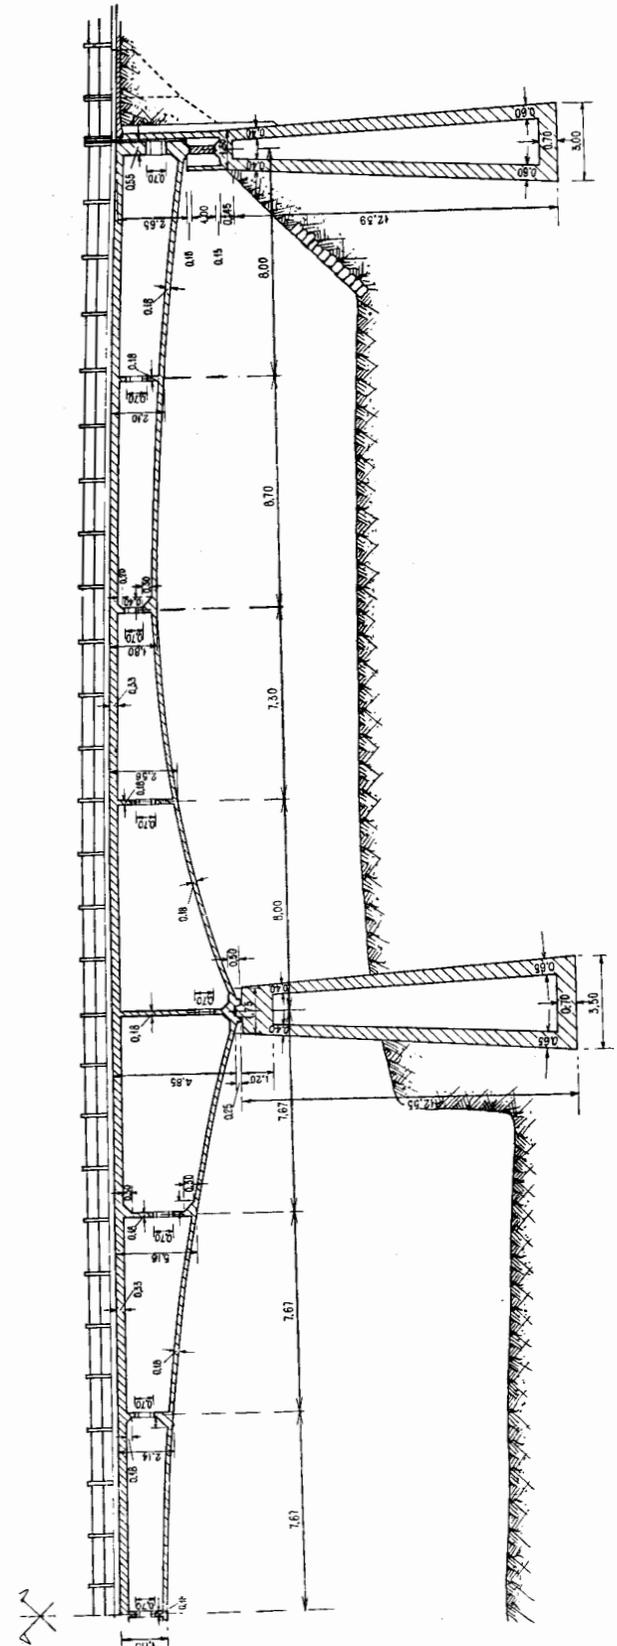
Puente sobre el Sauce Grande. — Semi-sección longitudinal por el interior de una viga hueca. Pilar de apoyo fijo y estribo de apoyo móvil, pendular, de hormigón armado.
